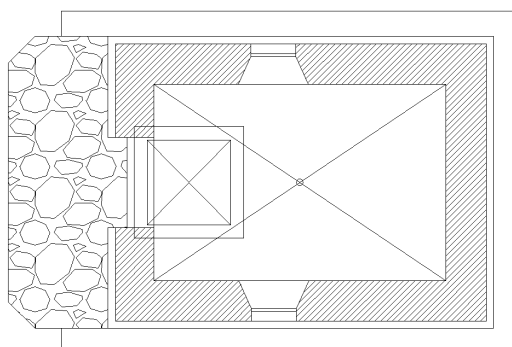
Grundriss der Kapelle (eigene Darstellung)
